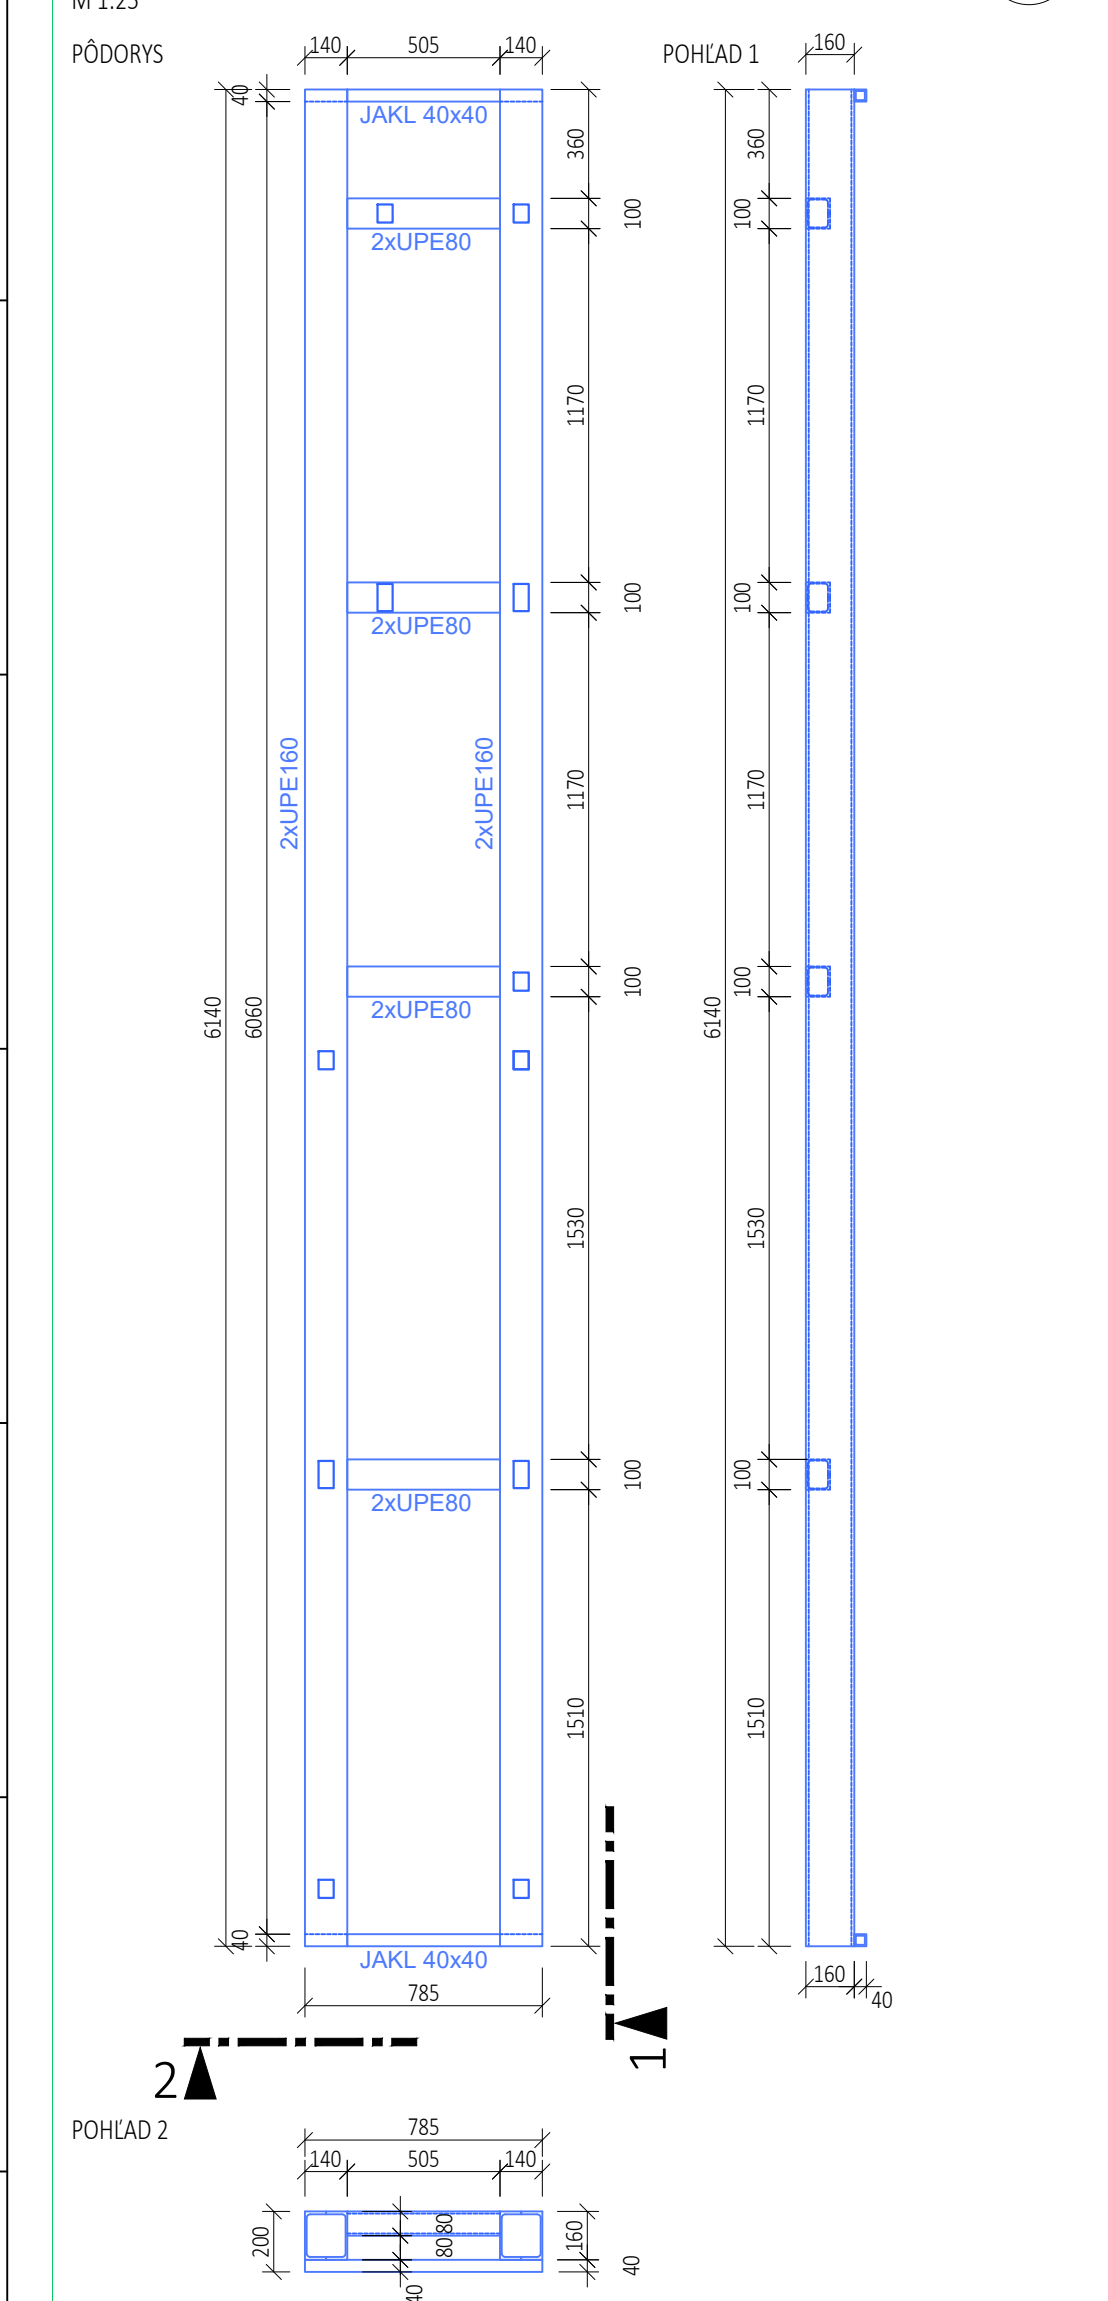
detail ocelevej konstrukcie pod VZT jednotky OK4
